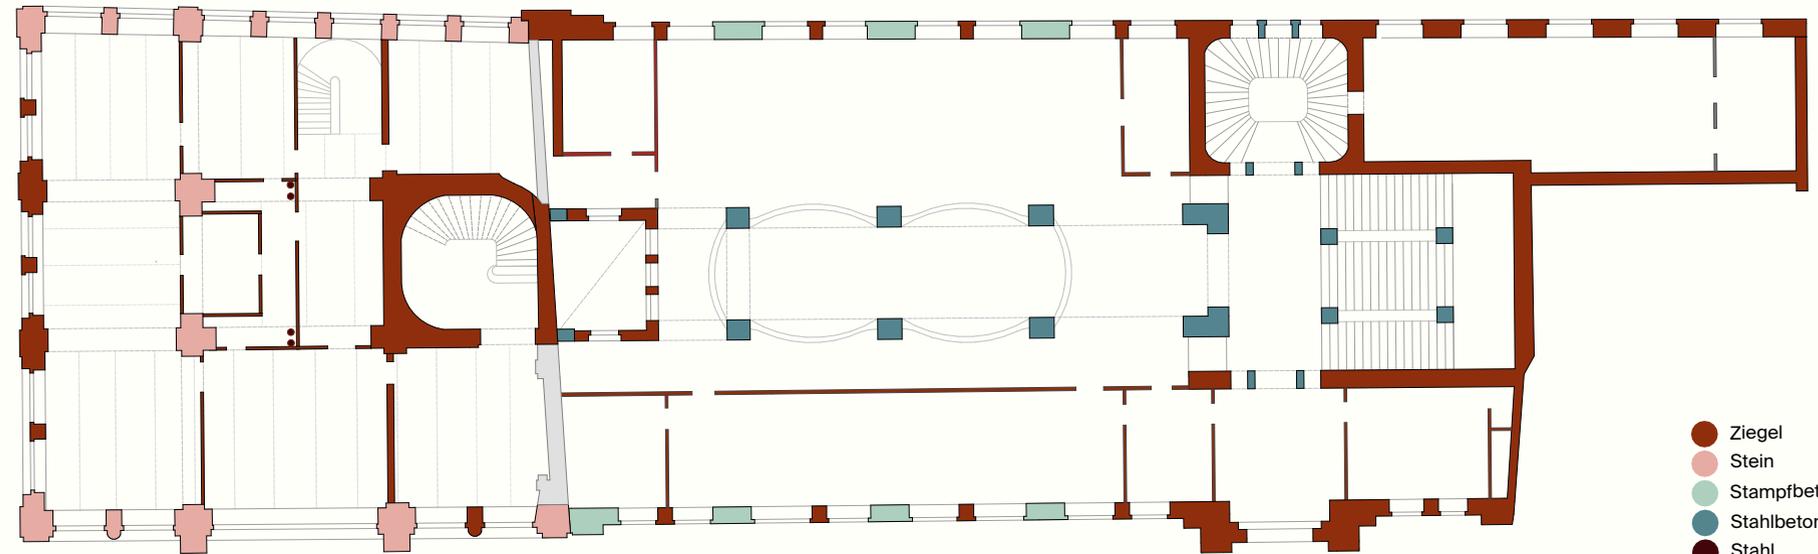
Haus am Hof inkl. Zubau, Grundriss Parterre
